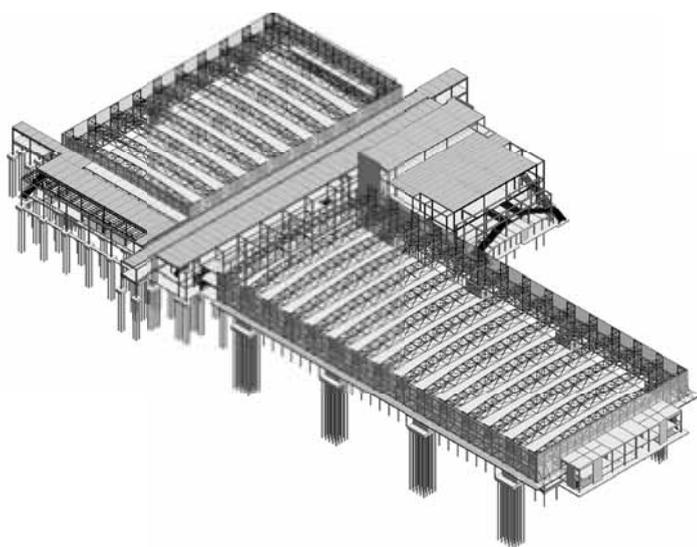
Modello BIM (realizzato con Revit) del sistema strutturale globale
